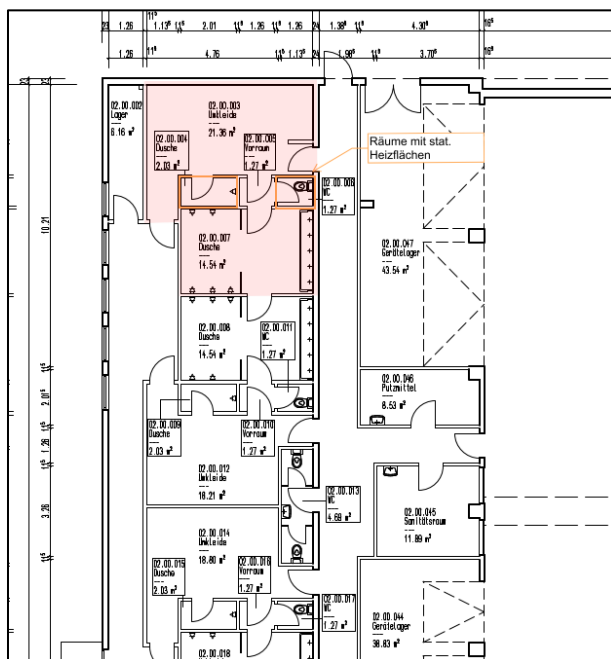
Ausschnitt aus dem Grundriss der Turnhalle
